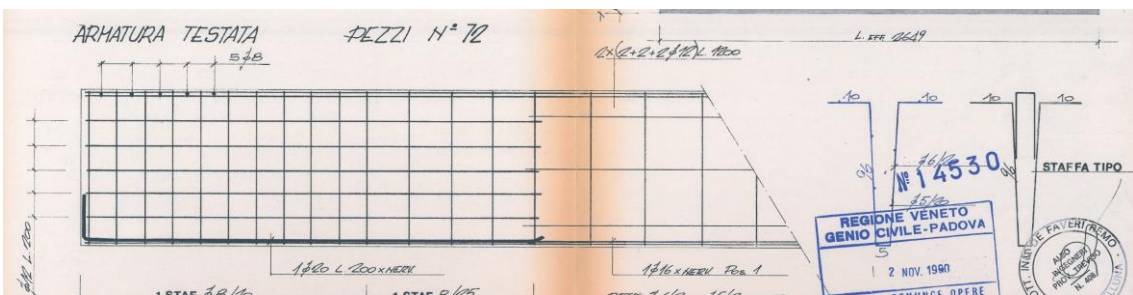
Particolare di A.1990.cap.us.T17 - Armatura tegolo h 100-7 - Sezione longitudinale
